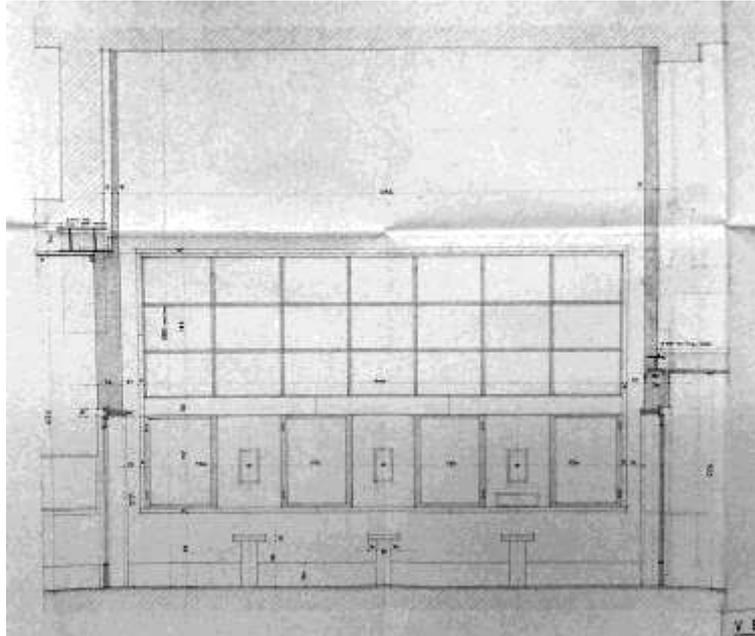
Rez-de-chaussée inférieur, élévation des nouveaux guichets, CFF Division des travaux Section des bâtiments, 26.8.1950 (CFF Lausanne Infrastructures, 356/3/Vevey/1912/2).
